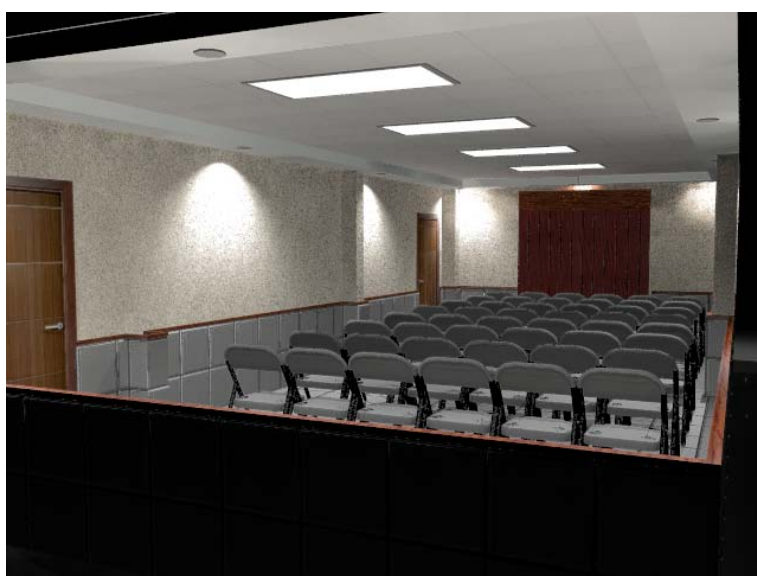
Vista Frontal del Salón de Pila Bautismal
